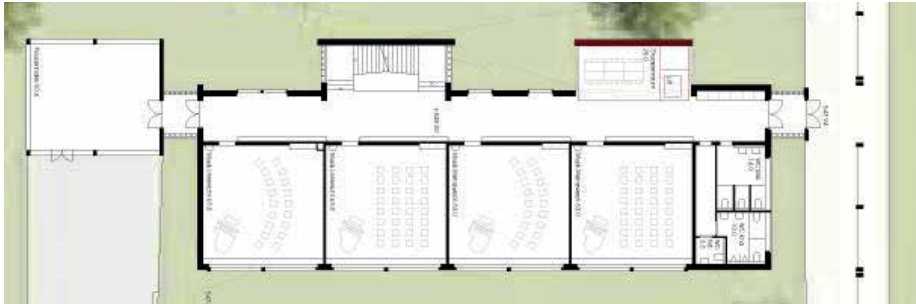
Schultrakt Manuel: Grundriss Erdgeschoss. Im Projekt von dadarchitekten, Bern, vorgesehene Neubauteile in rot
